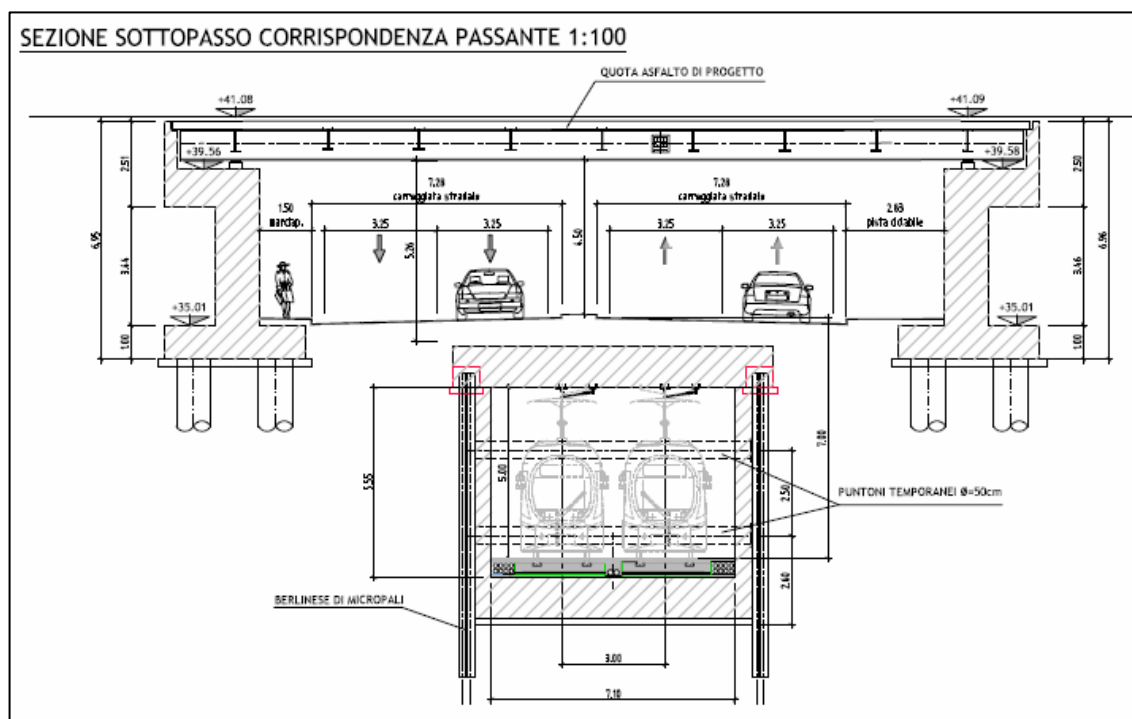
Sezione trasversale sottopasso al di sotto della tangenziale
